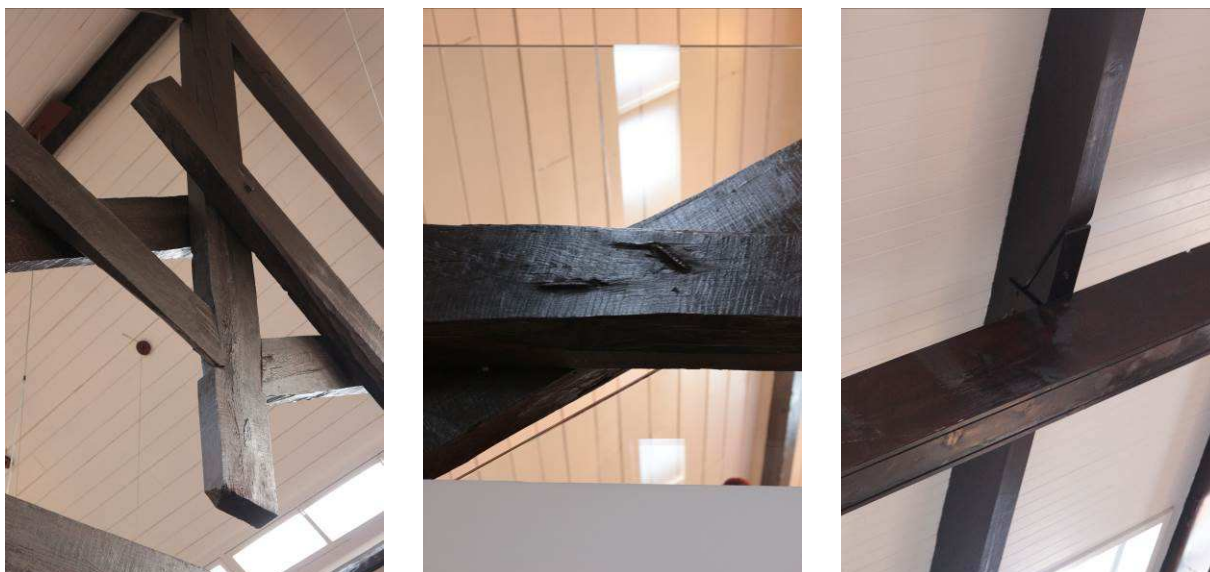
Tipos de ligação e pormenores da estrutura da cobertura do Salpoente
